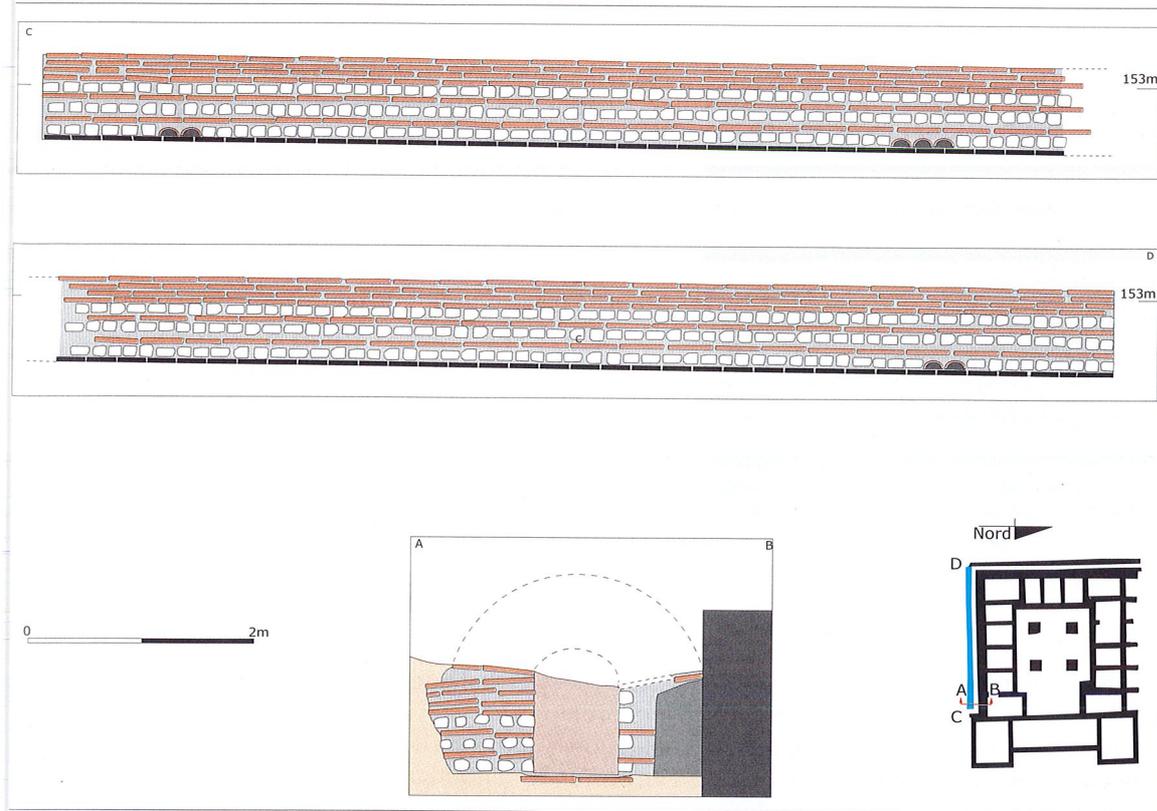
Coupe et élévation du canal de drainage. Infographie L. Grimbert INRAP.
